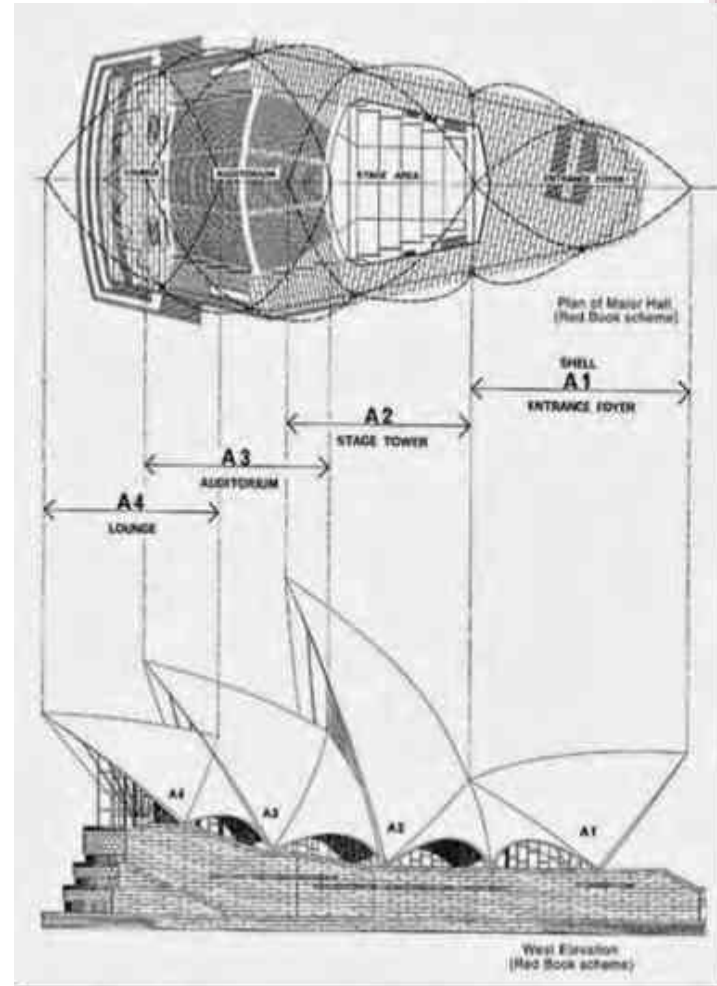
Planta y alzado del Teatro de la Ópera de Sydney
